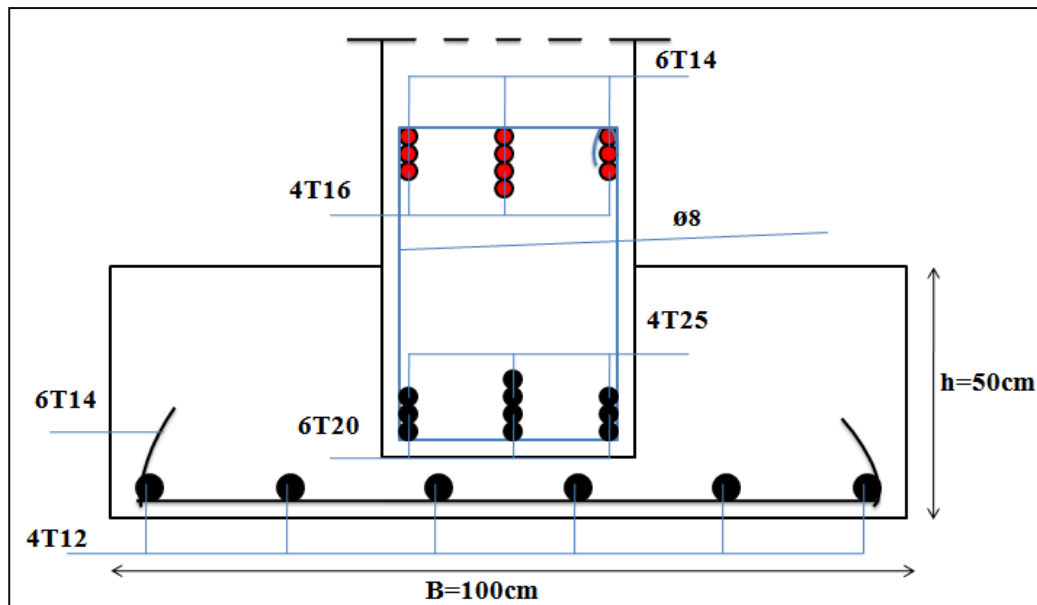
Ferrailage de semelle continue sous poteaux
